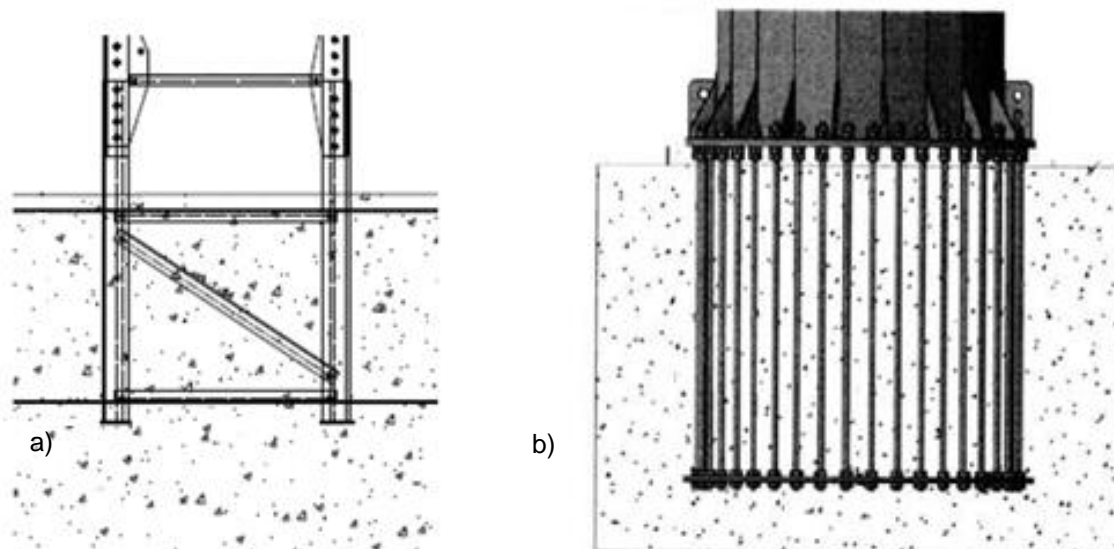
Elementos de ligação da estrutura à fundação: a) Embebimento da torre e b) Chumbadouros
